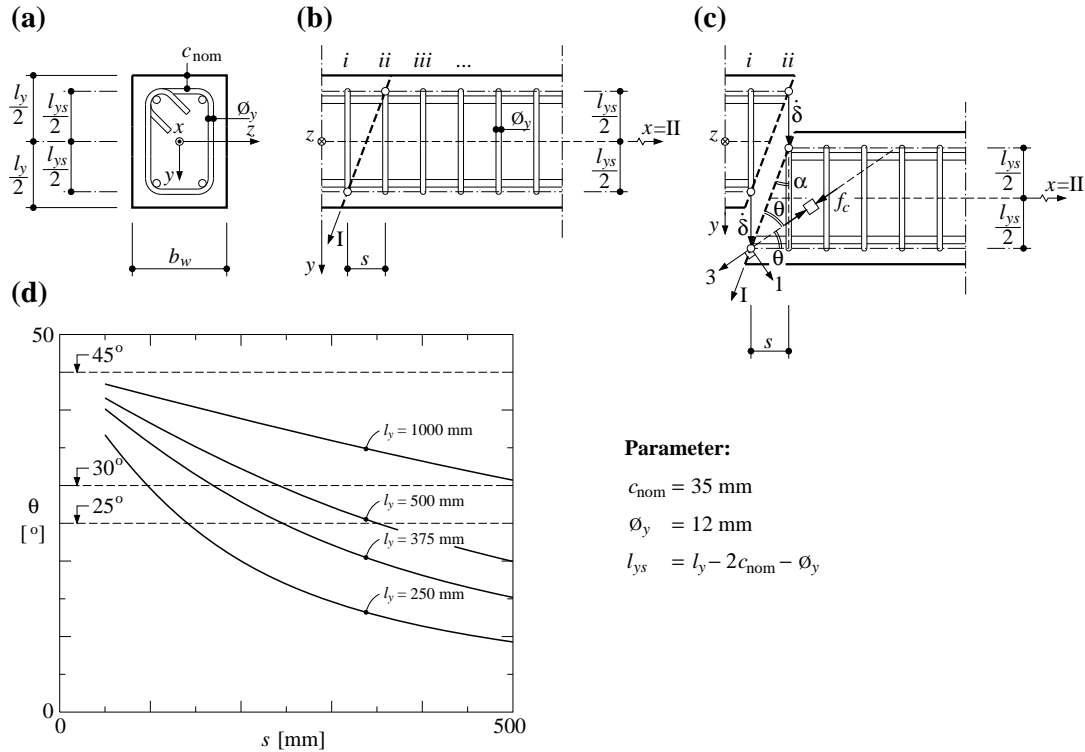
Stegdruckbruchmechanismus eines Stahlbetonträgers: (a) Querschnitt, (b) Trägersteg mit charakteristischen Richtungen (Gleit- Bruchlinie), (c) Kollapsrissmechanismus mit Haupttrichtungen, (d) Schranken der Druckfeldneigung.
